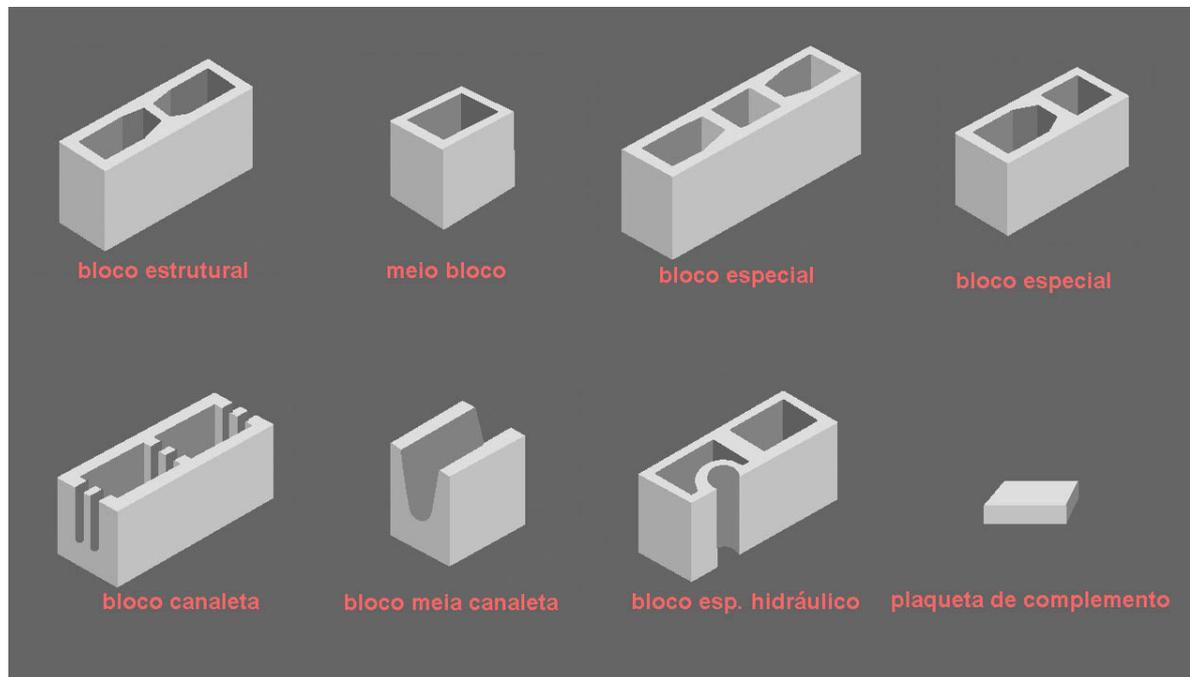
tipos de blocos estruturais de concreto (adaptado de TECMOLD PISOS E BLOCOS DE CONCRETO, [200-])
